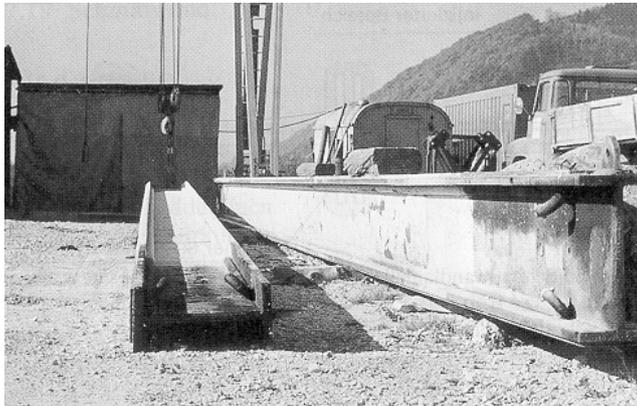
Rüttelbohle mit Suspensionsleitungen [3]
